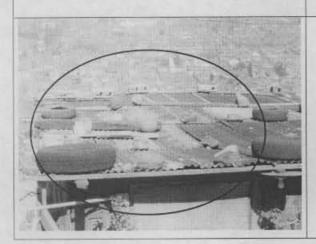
Elementos inadecuados como llantas y piedras que apoyan las tejas de cubierta.
